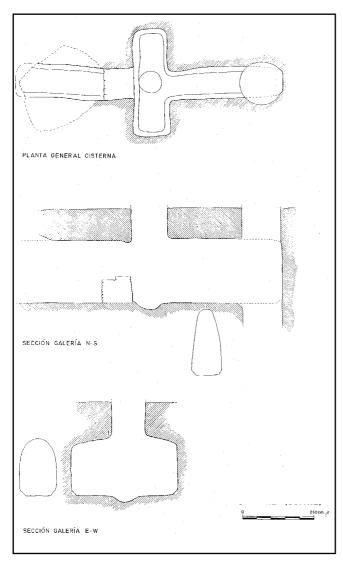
Pozo Nuevo 5. Sector I. Cisterna (A), planta y secciones
